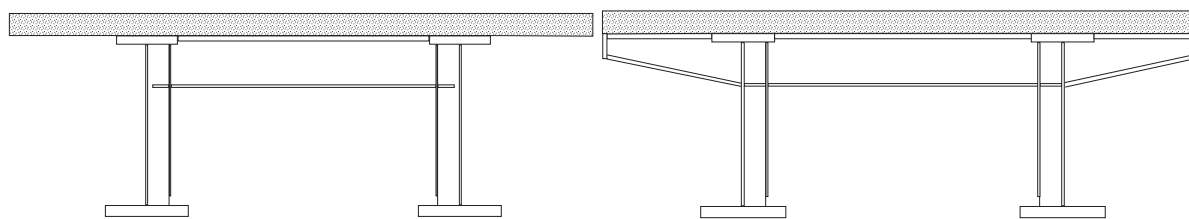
Exemples de sections avec entretoises supportant la dalle
